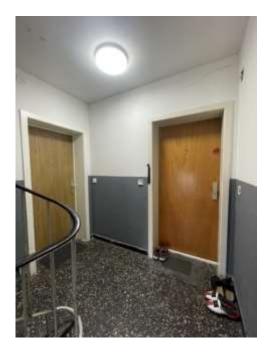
Treppenhaus 3.OG Kaiser-Friedrich-Straße
